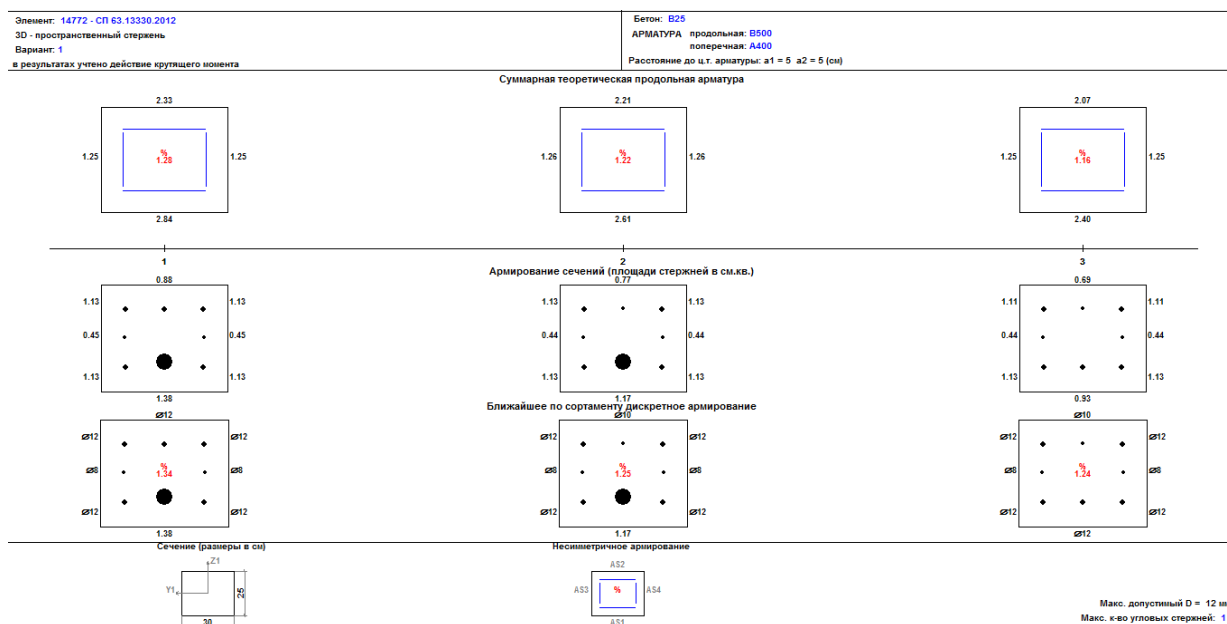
Схема армирования ригеля (выполнено в программе SCADOffice)
